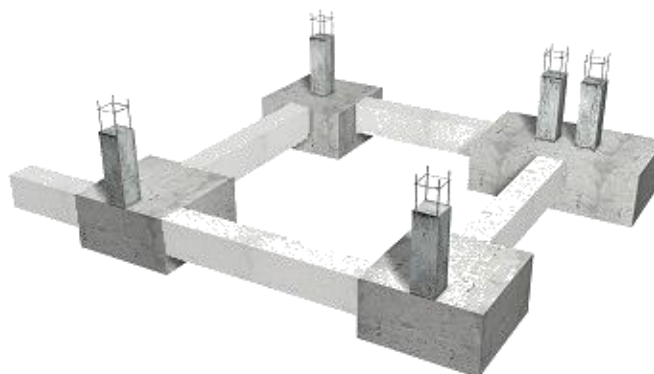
Modelo de cimentación planteado mediante zapatas
